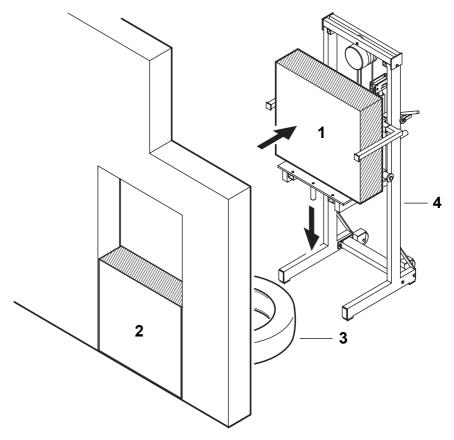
Estrazione di blocchi ricavati dalla parete e sollevati con un elevatore
